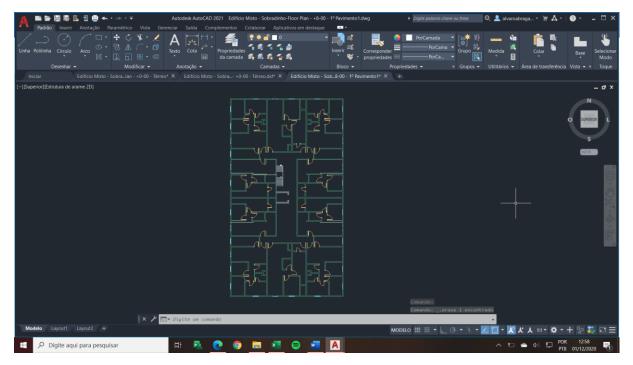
Planta baixa do pavimento tipo, em DWG. Realizado pelo autor.
